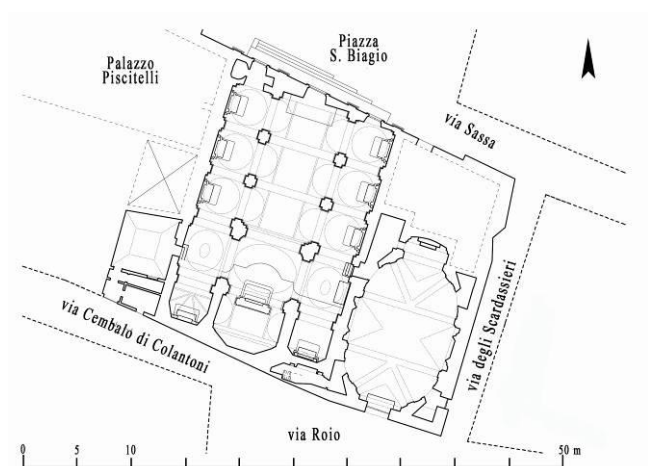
Pianta generale del complesso di San Biagio. A destra l'aula ellittica dell'Oratorio.
